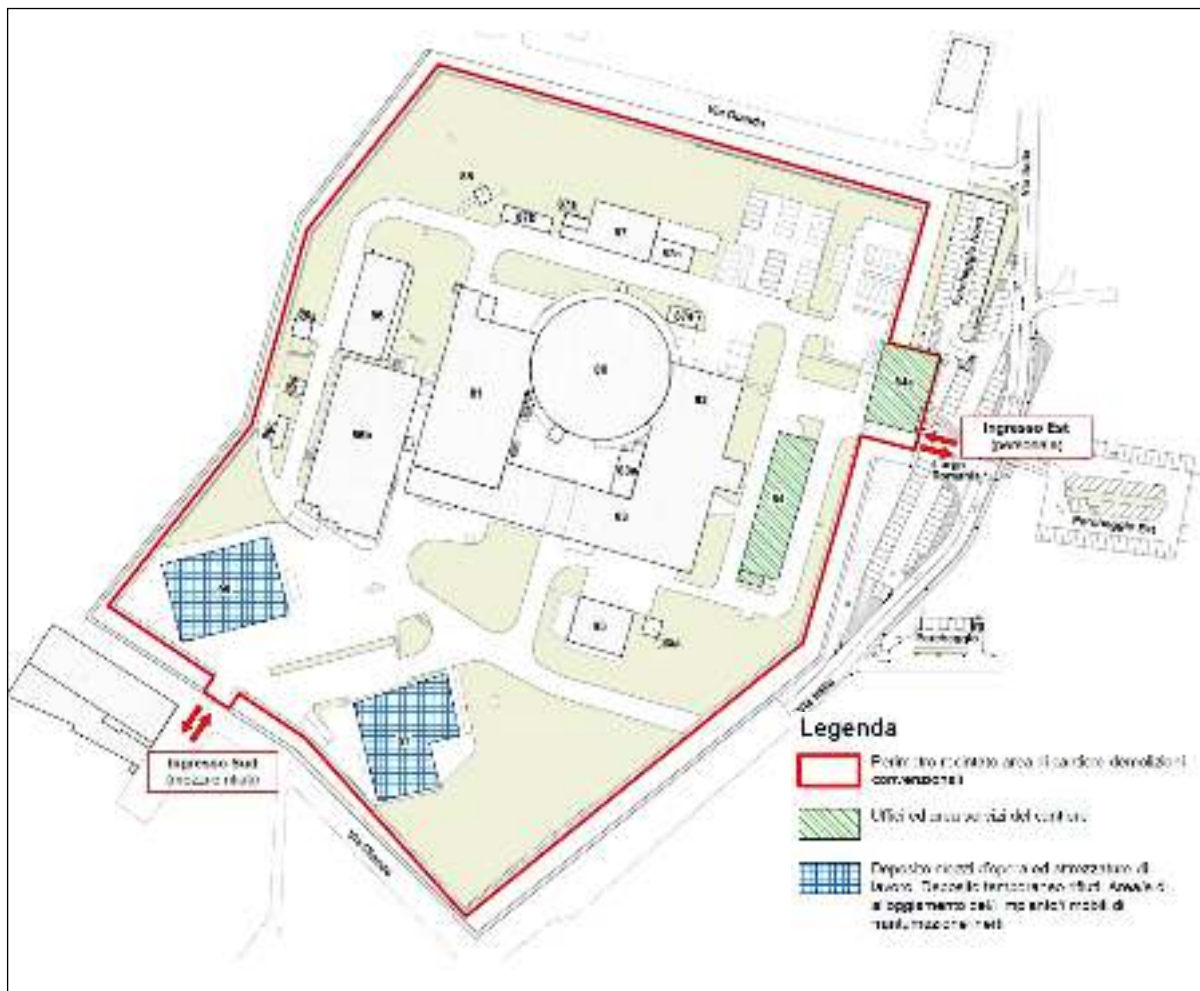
Planimetria del sito con individuata l'area di cantiere
